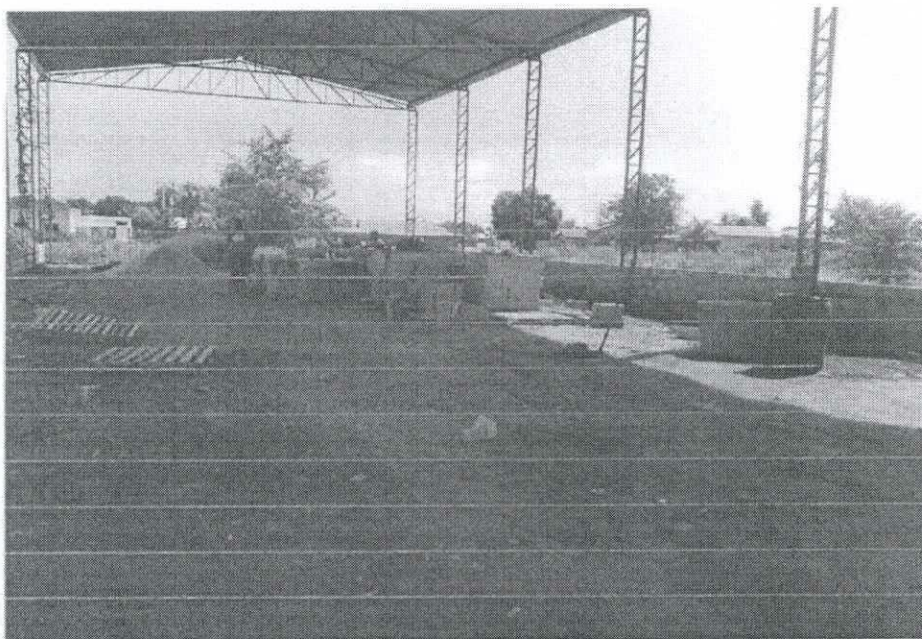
Os mesmos pilares de estrutura metálica agora com reforço, com vigas aéreas em blocos de canaletas, com aço CA 50, concretados sob a minha responsabilidade:
